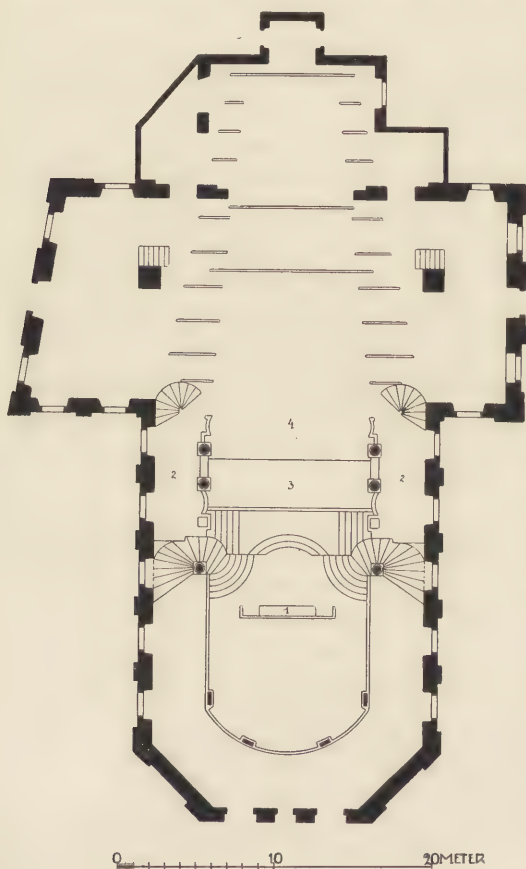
Comödienhaus von 1667, Grundriss.
